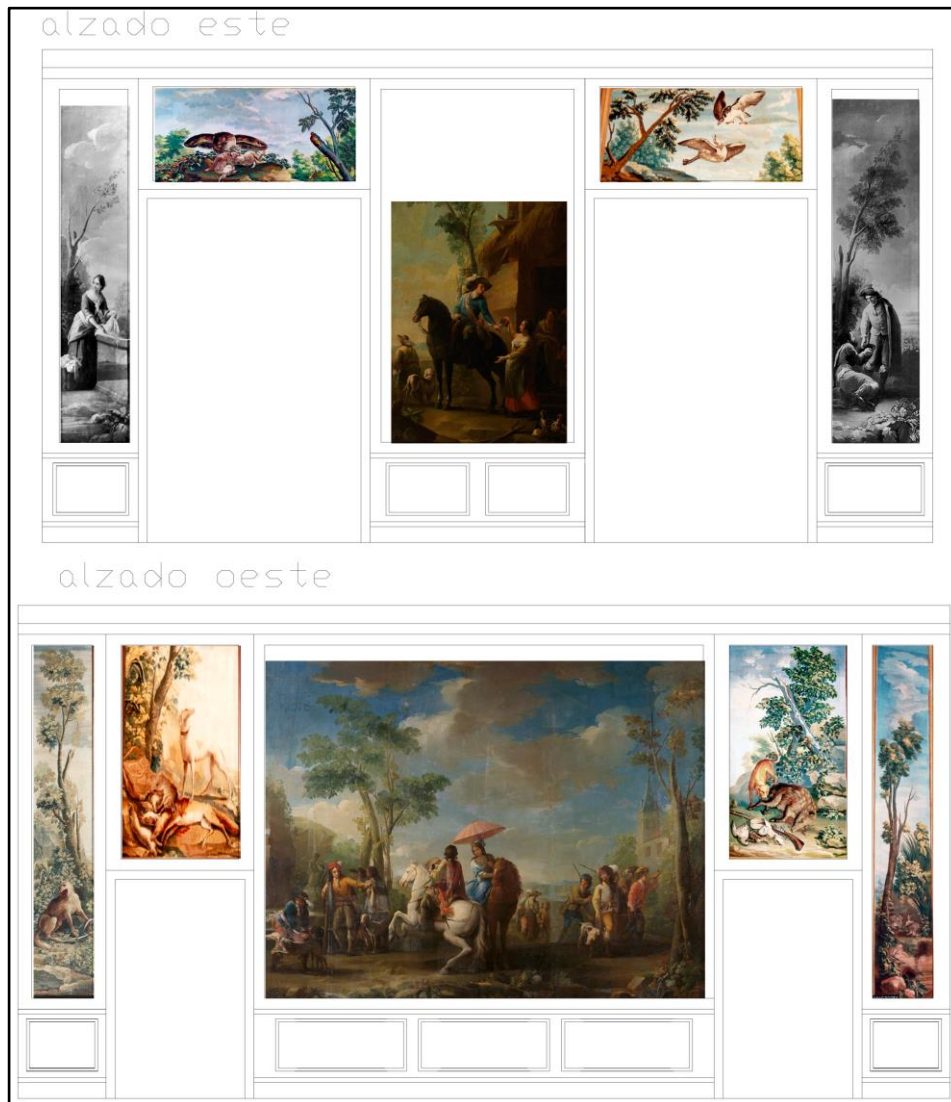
Reconstrucción de los alzados este y oeste de la Pieza del Dormitorio, según los autores (alzados realizados por Diego Ruiz-Vernacci Lozano).
